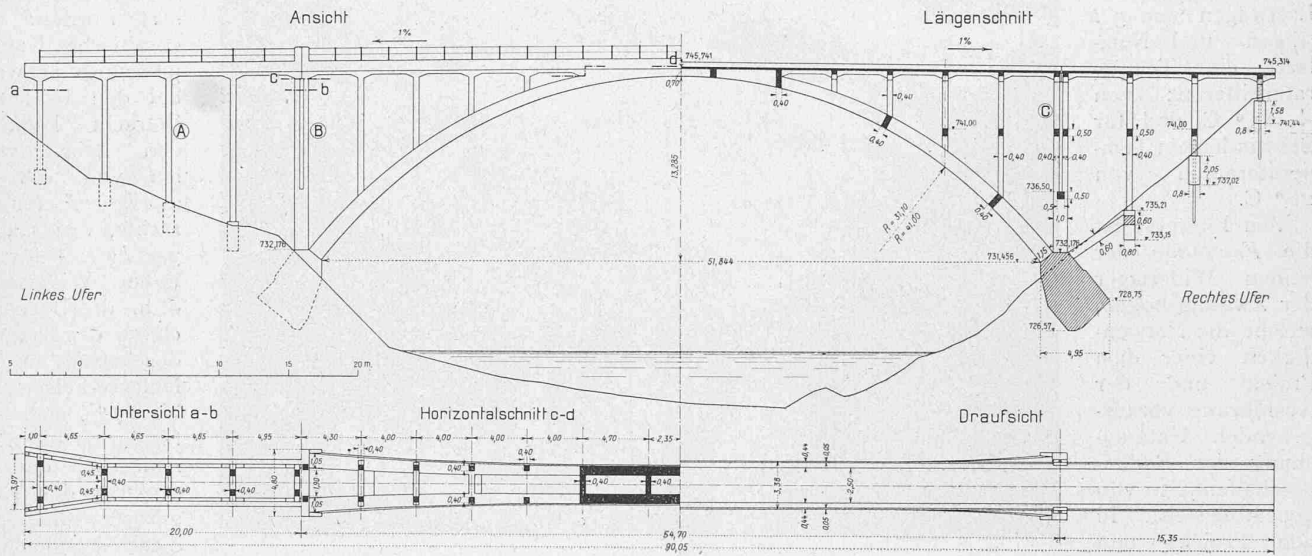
Ansicht, Vertikal- und Horizontal-Schnitte und Draufsicht der Scheeren-Brücke. — 1:500.
